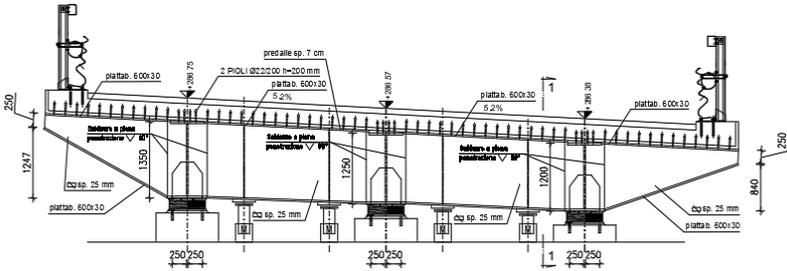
Impalcato: Sezione su pile e spalle
